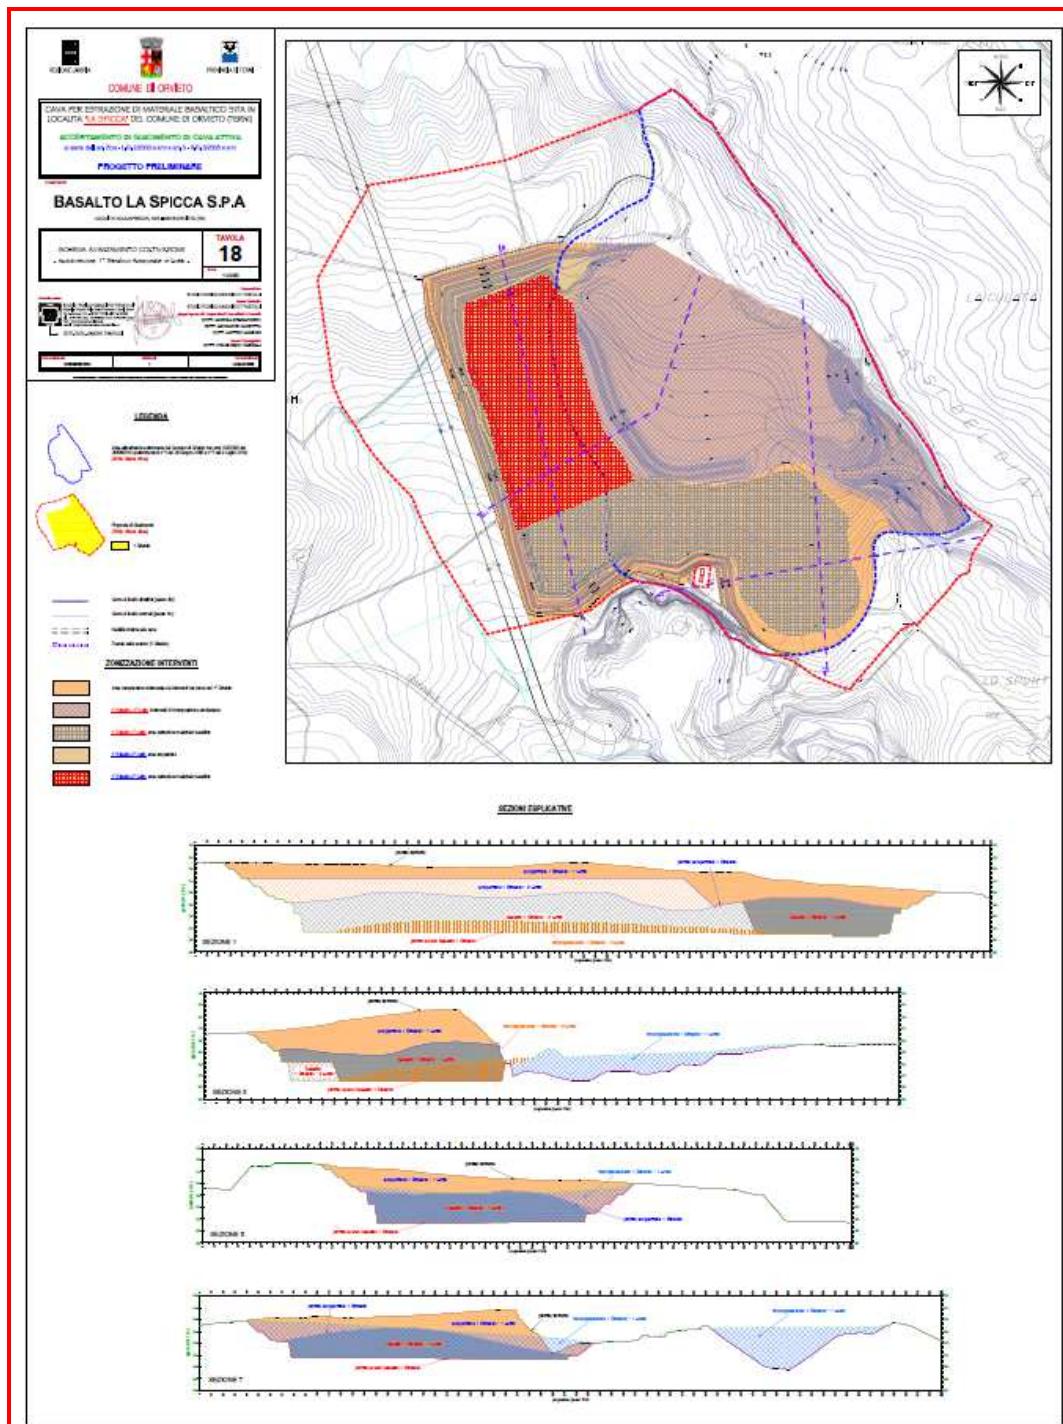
Schema di avanzamento coltivazione, Suddivisione 1° Stralcio Funzionale in Lotti
